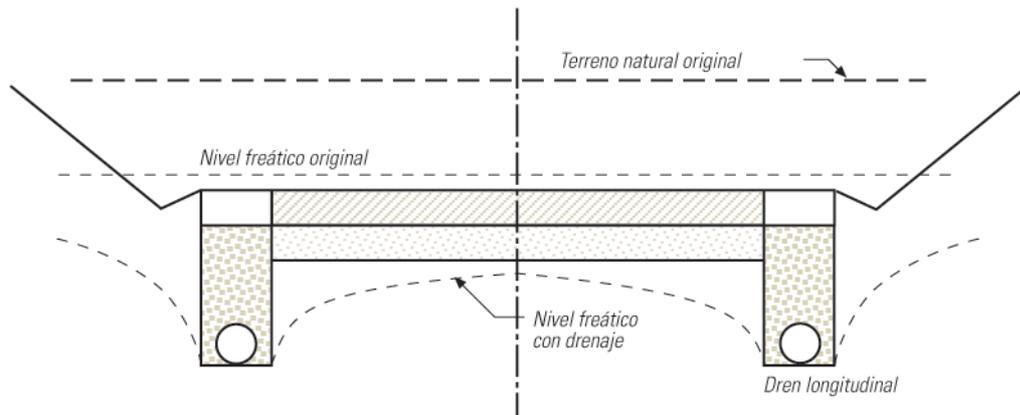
Drenes longitudinales para rebajar el nivel freático en carreteras de calzada doble
